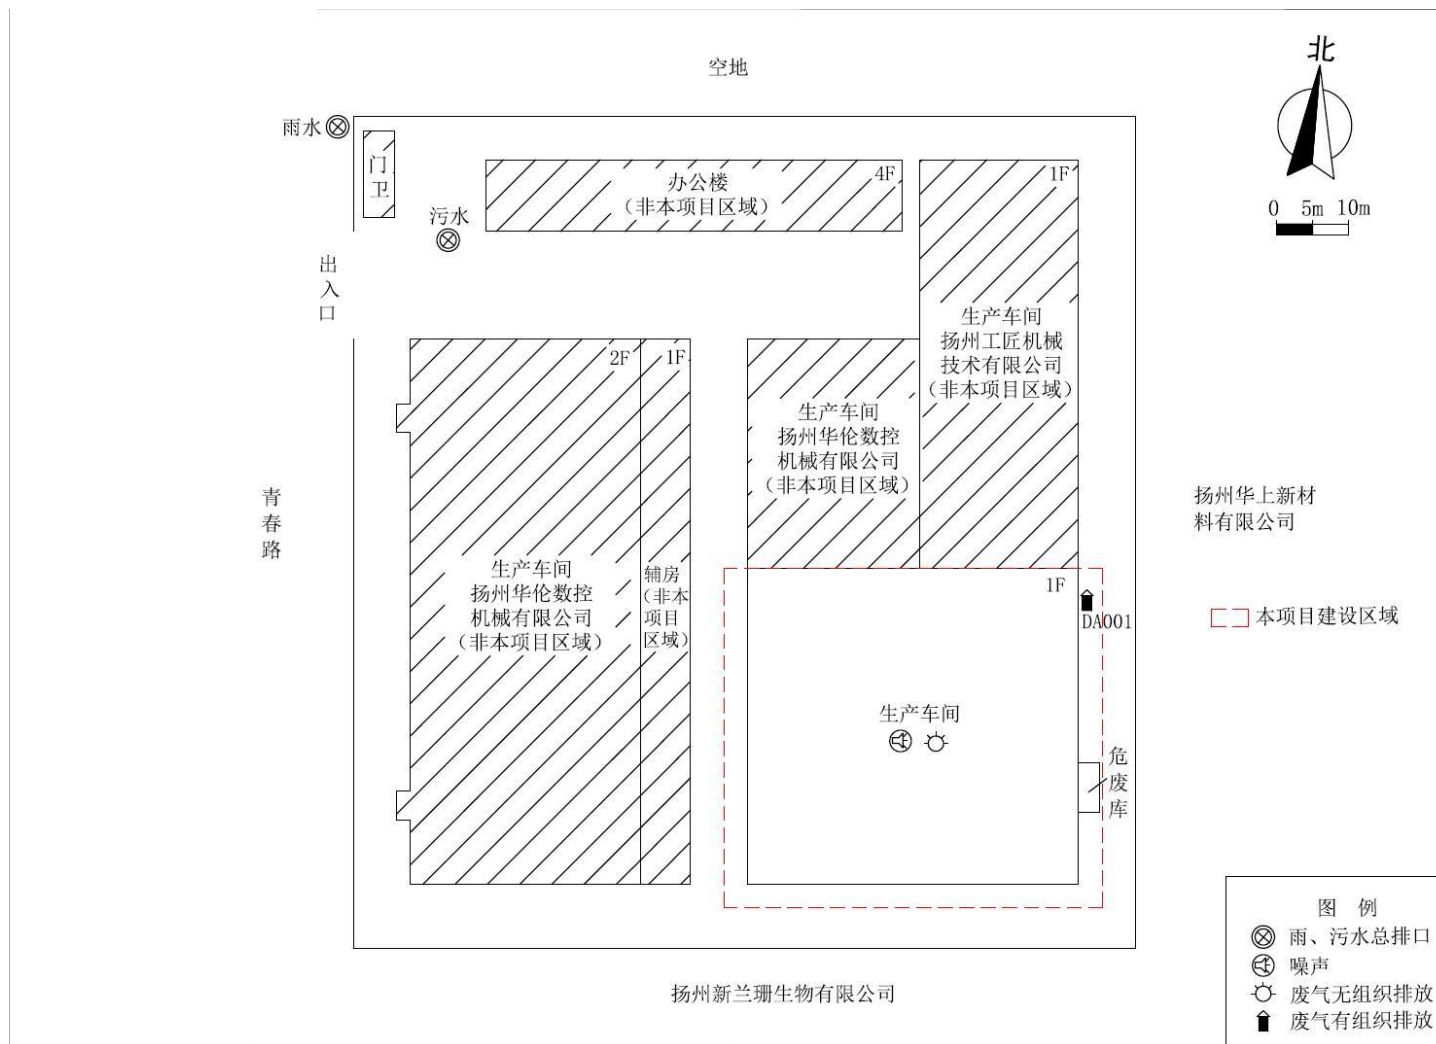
厂区总平面布置图（与环评中基本一致）
